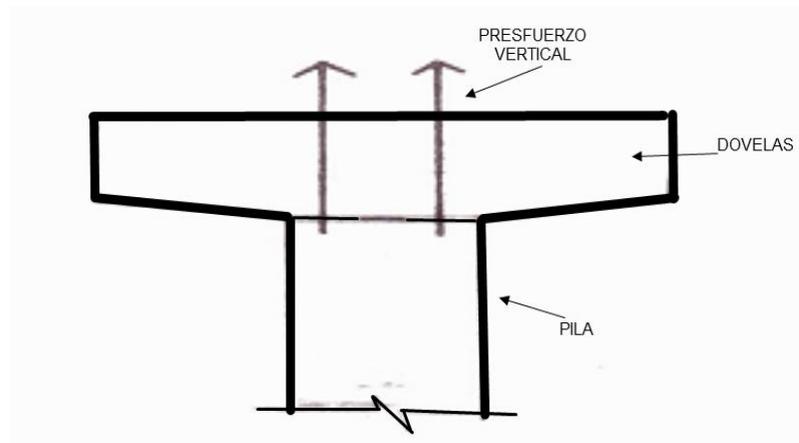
Uso de cables para presfuerzo parcial vertical para mantener simetría en cargas durante la construcción de voladizos
